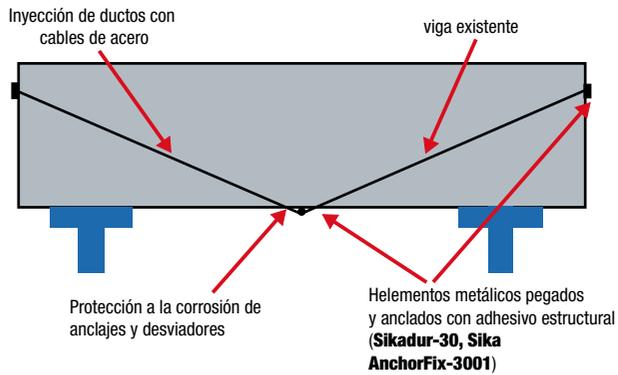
Colocación de cables tensados externos de acero o de FRP en reforzamiento de viga
